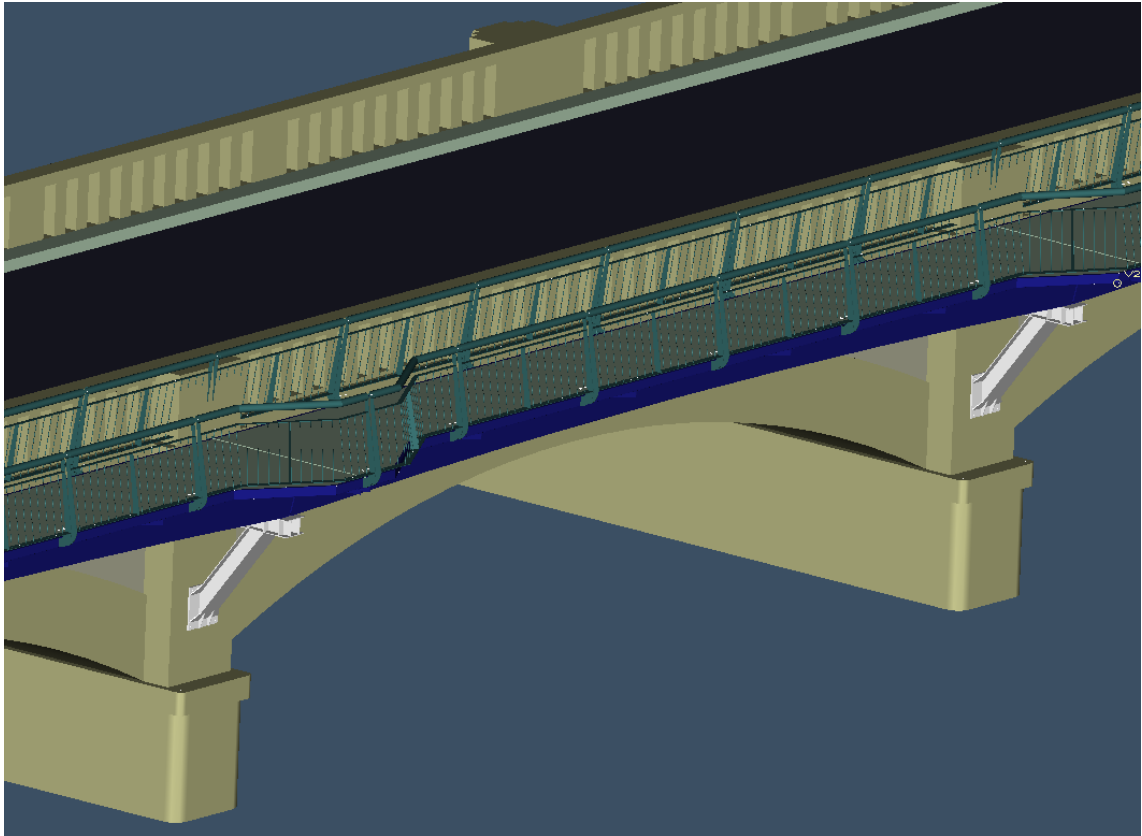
Detalle pasarela peatonal con apoyos puente hormigón
